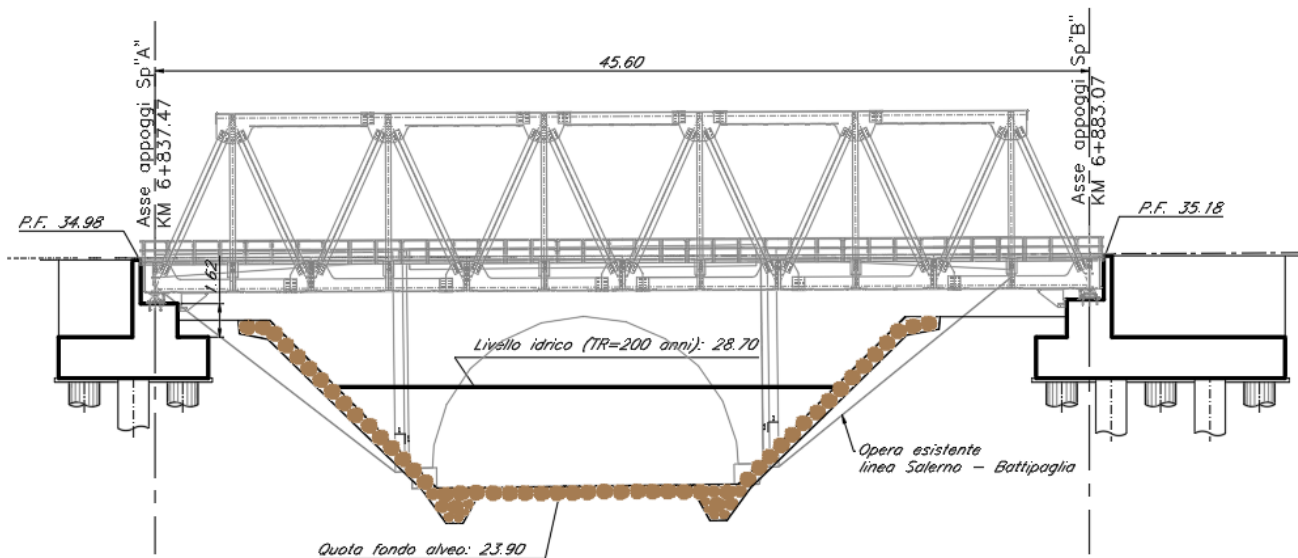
Profilo longitudinale VI-03 Ponte Asa
